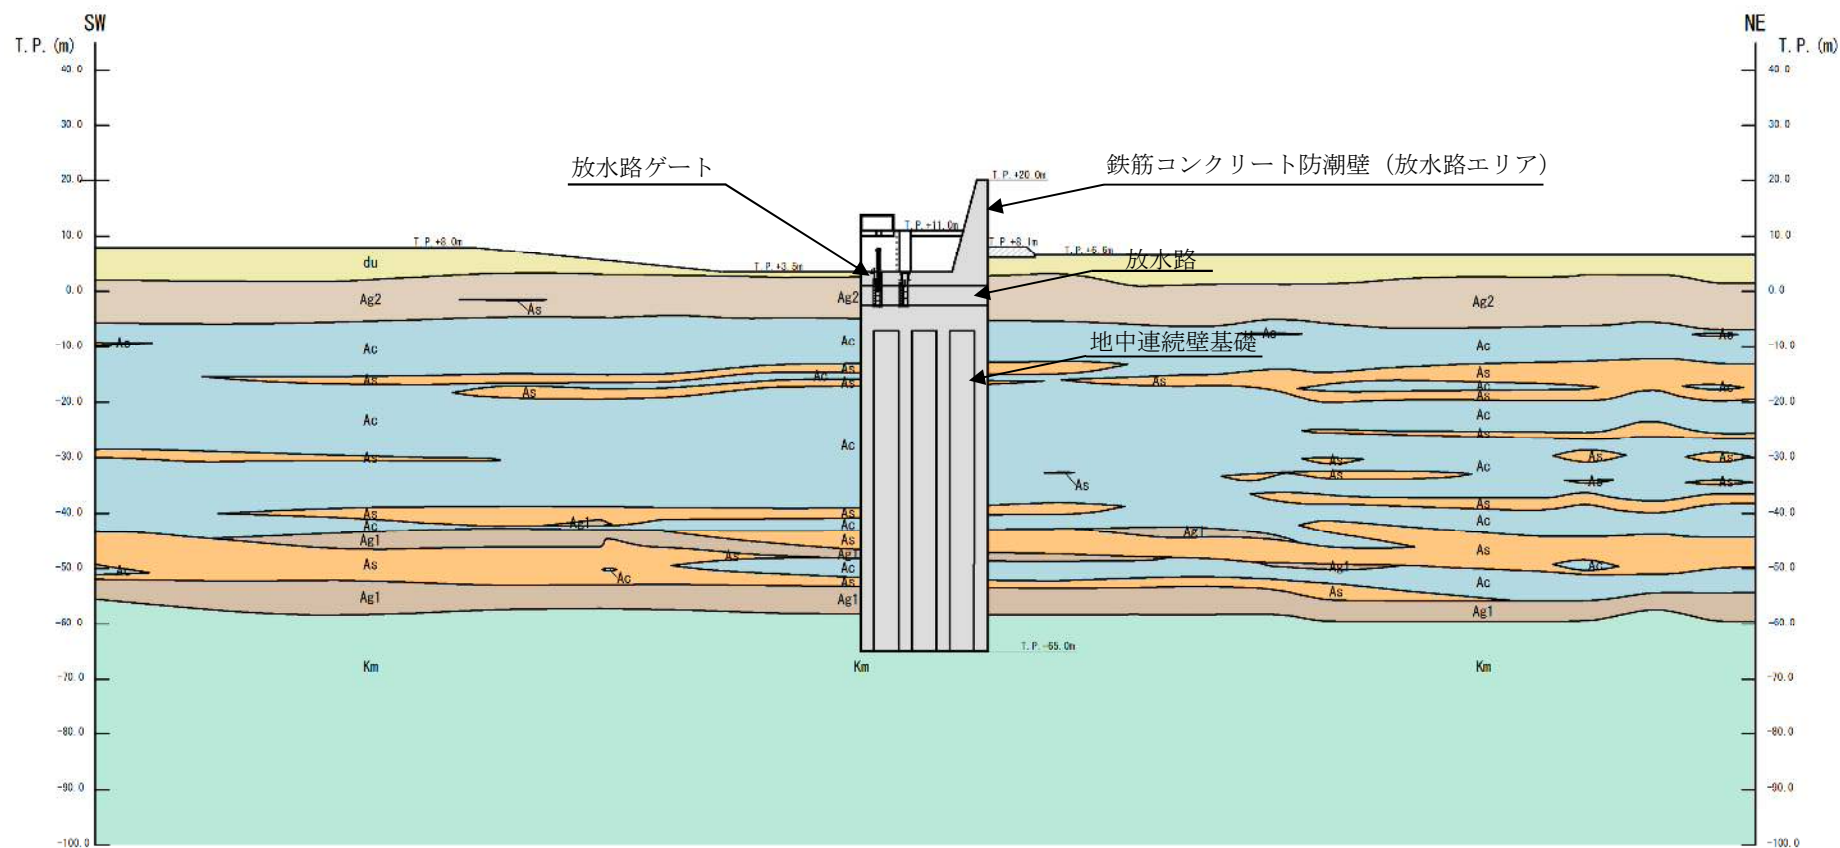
鉄筋コンクリート防潮壁（放水路エリア）の断面図（防潮壁横断方向：①-①断面）
